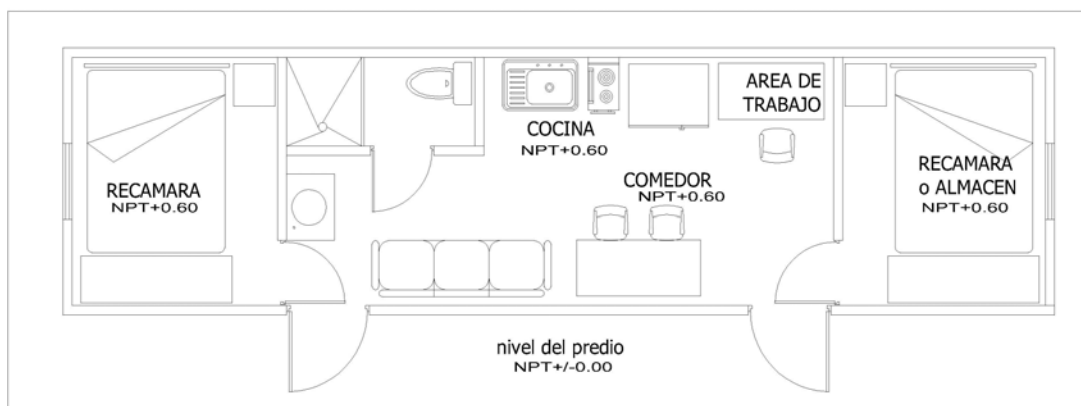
Planta arquitectónica del funcionamiento actual del camper
